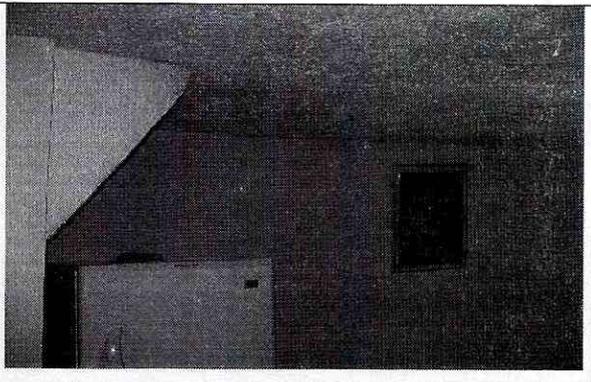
Muros de segundo piso, y placa de cubierta de la zona frontal en buenas condiciones
